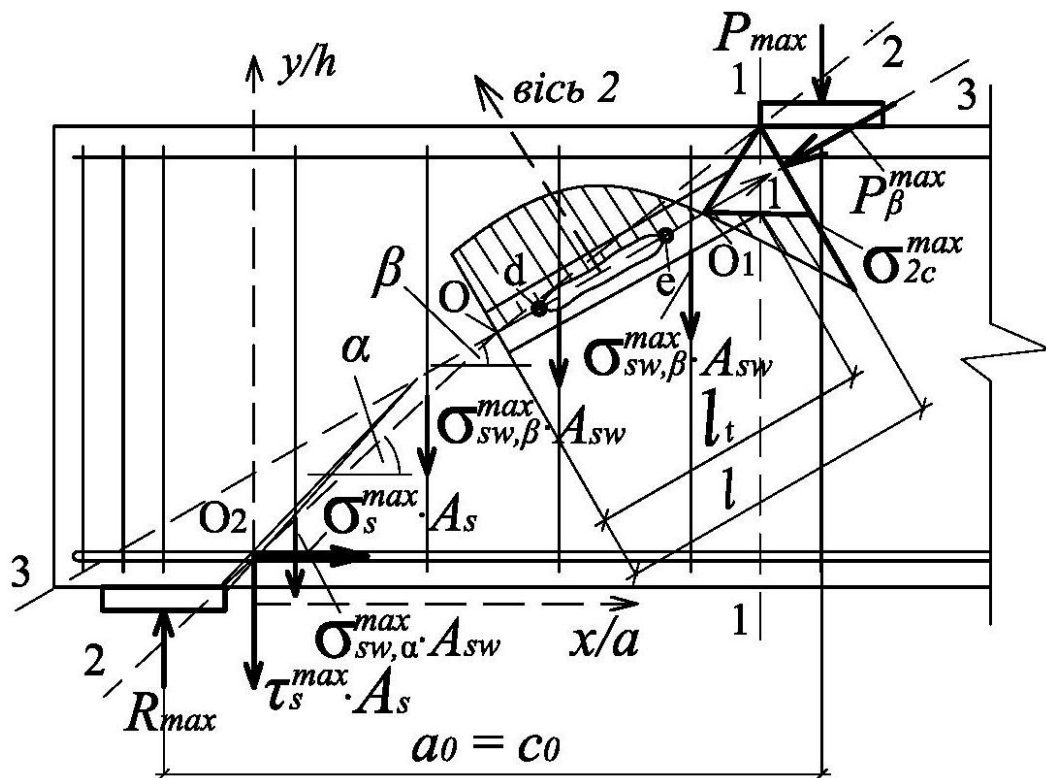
Фізична модель і розрахункова схема втомного опору похилого перерізу непереармованого залізобетонного елемента і з середнім прольотом зрізу
